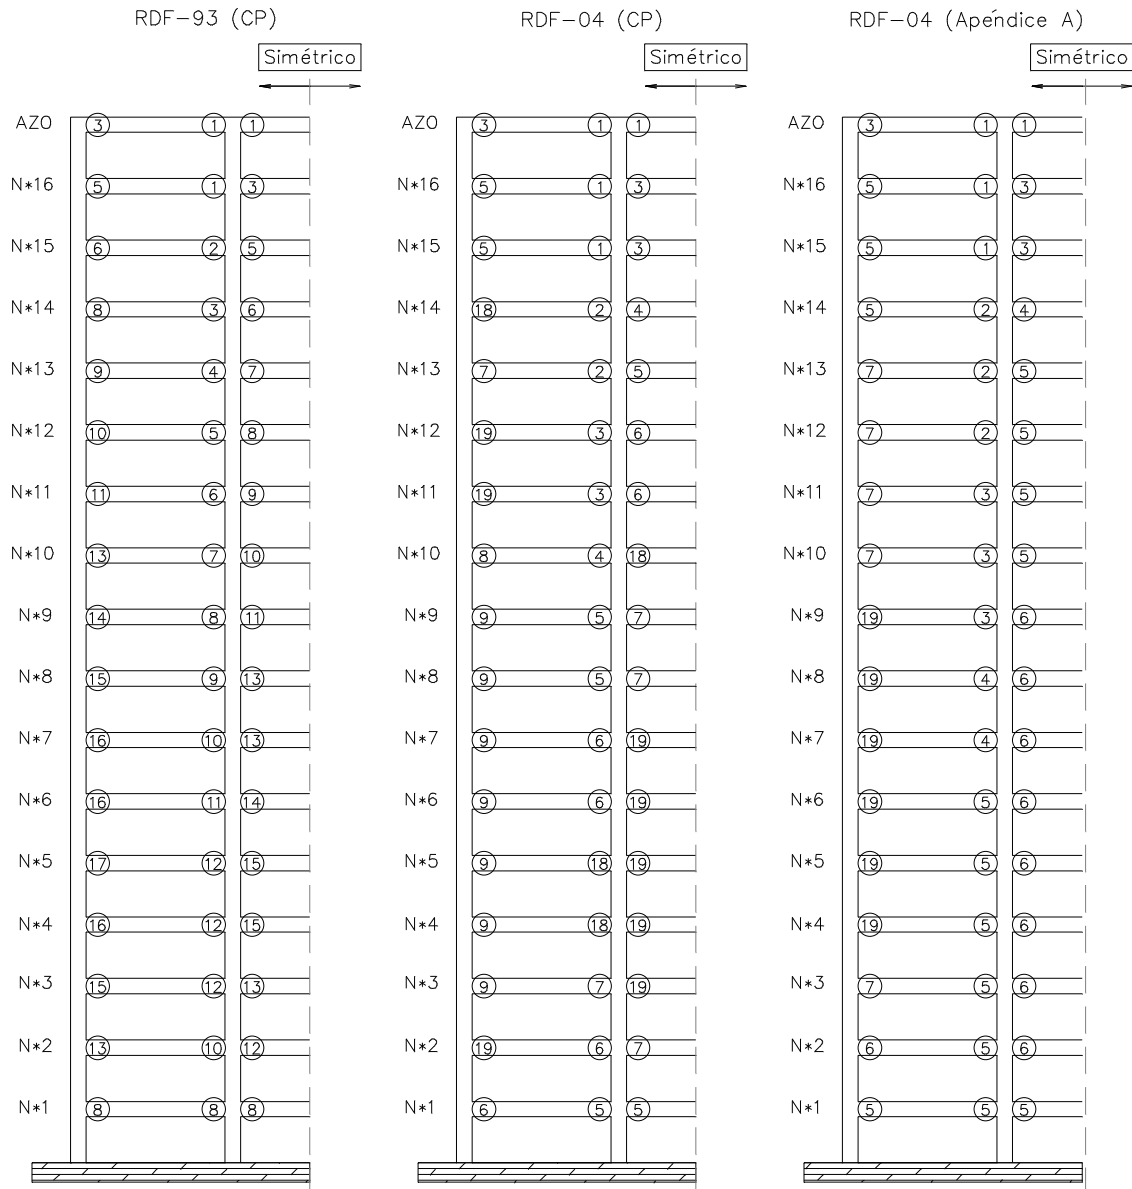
Ubicación de los tipos de armados de los extremos de las vigas del eje 2, estructuras de 17 niveles, diseños en zona II (RDF-93 y RDF-04)
